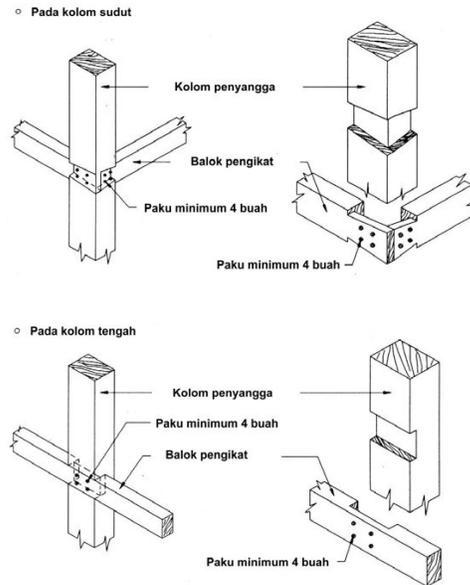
Detail sambungan tiang/kolom pondasi dengan balok penguat horizontal
